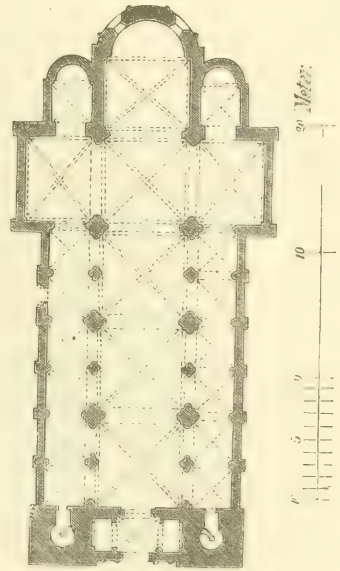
S. Fides zu Schleifstadt. Grundriss.
